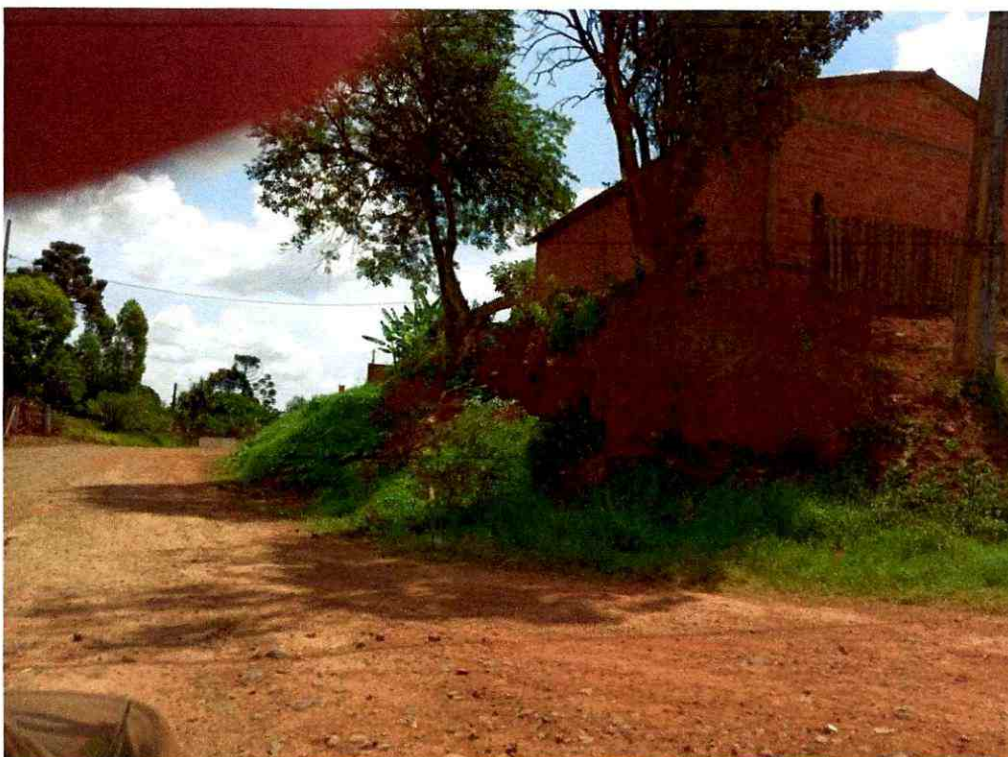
trecho Leste → Oeste – local onde será executado muro de arrimo para passeio
